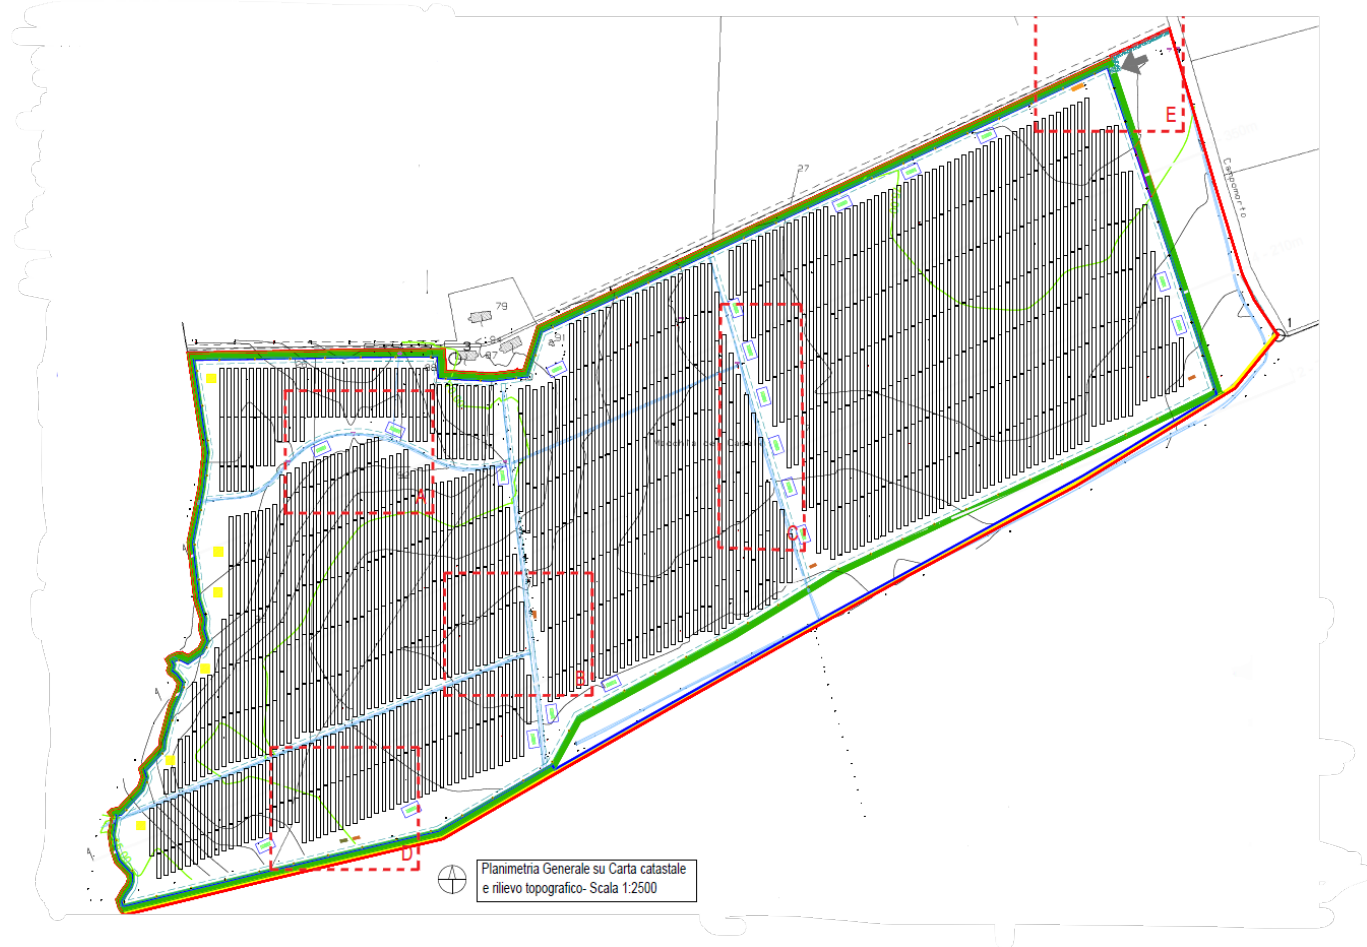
Stralcio nuovo layout dalla tavola aggiornata TAV07 - PLANIMETRIA DI PROGETTO
